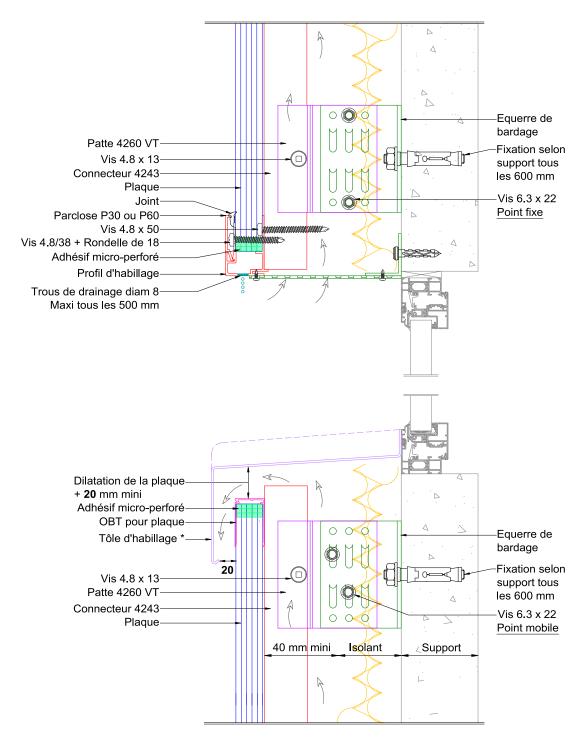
Encadrement d'une baie en feuillure - Coupe verticale
